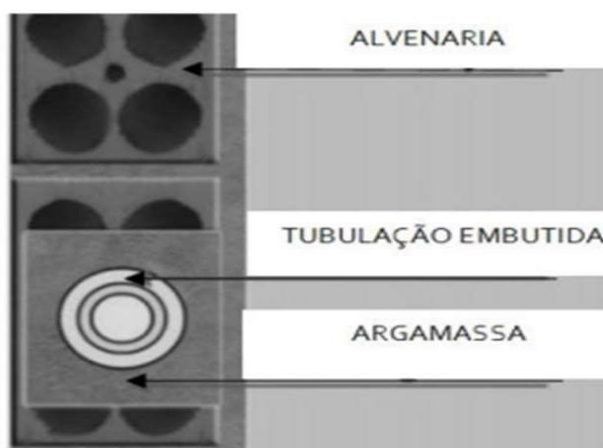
Vista de um corte exemplificativo de envelopamento em alvenaria.
